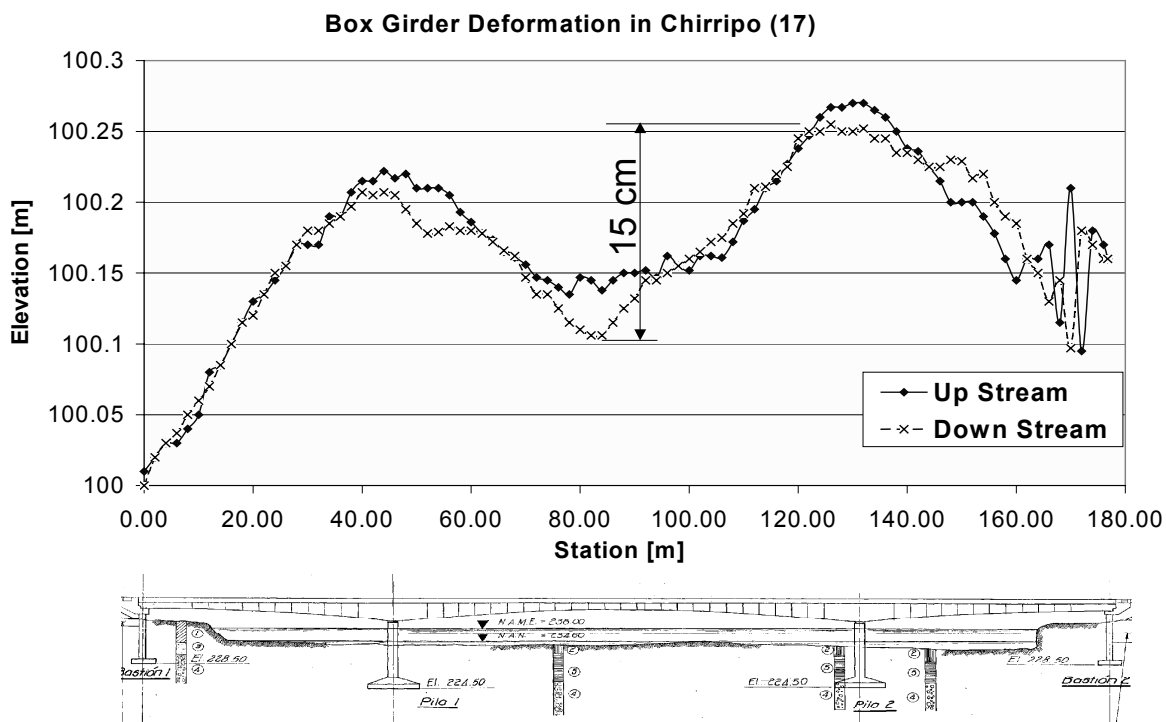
Deformación de las Viga Cajón en el Puente sobre el Río Chirripó (No.17)
